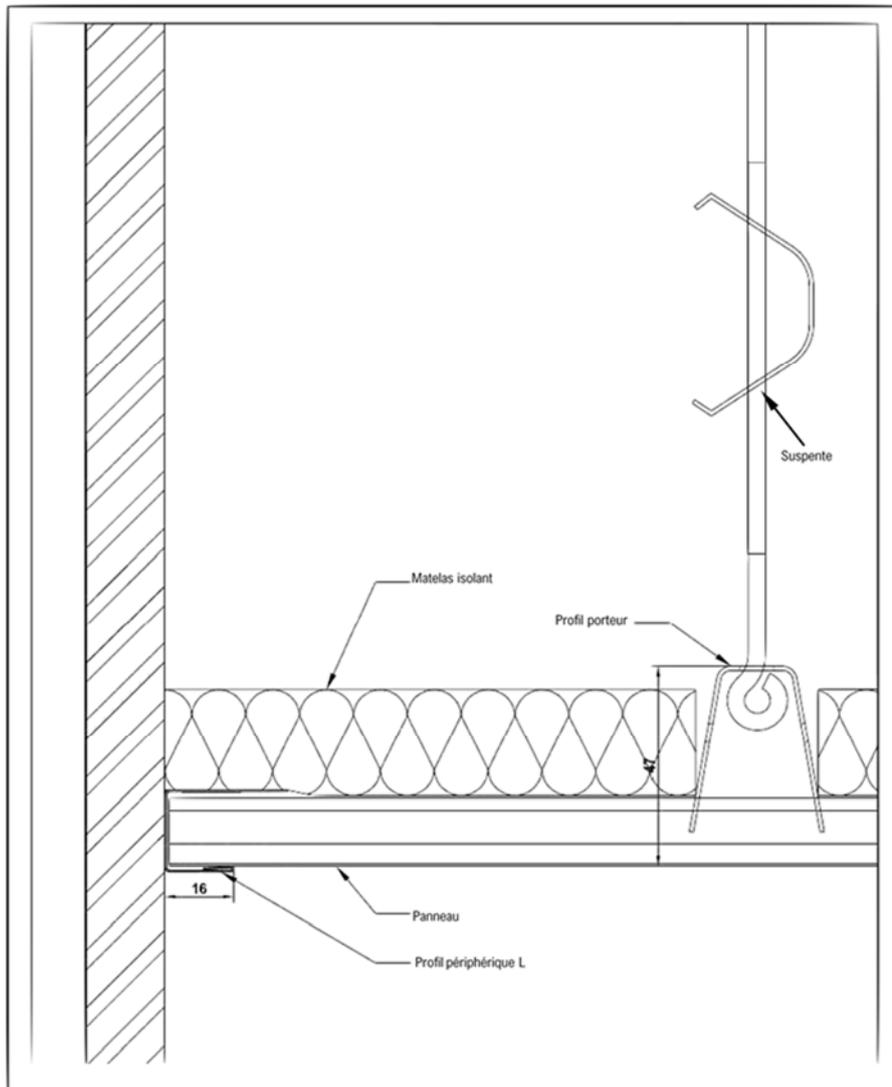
coupe longitudinale du plafond Easy-Klima Plus®
